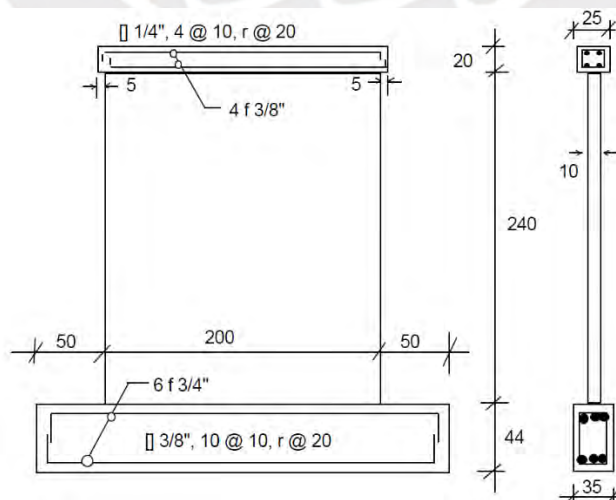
Detalle estructural de placas ensayadas (San Bartolomé, 2003)
